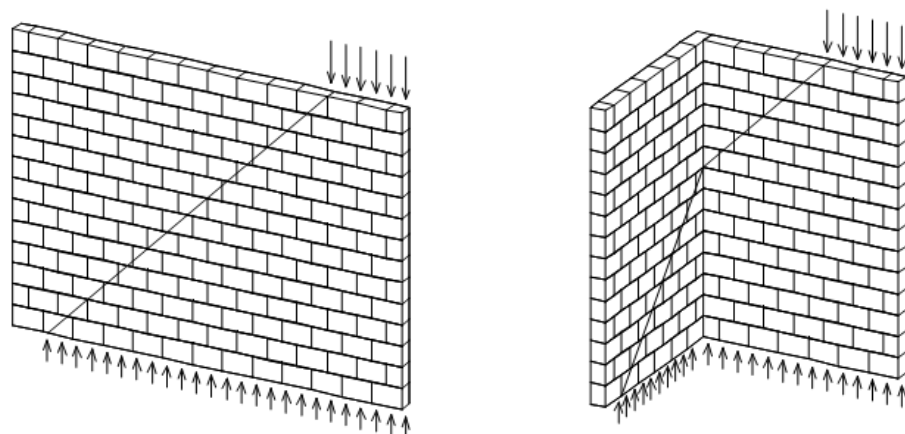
Espalhamento do carregamento em paredes planas e em "L". (RAMALHO, 2003)
